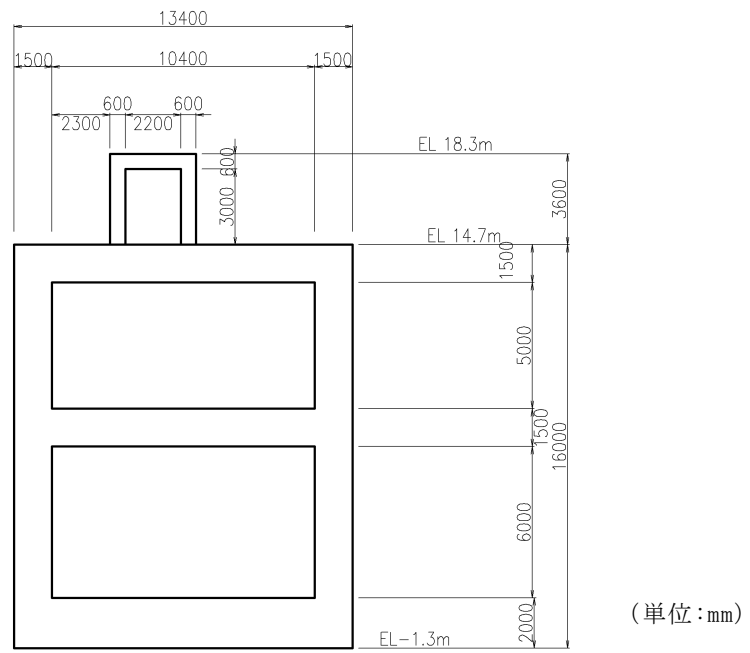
低圧原子炉代替注水ポンプ格納槽 断面図 (A-A 断面)
